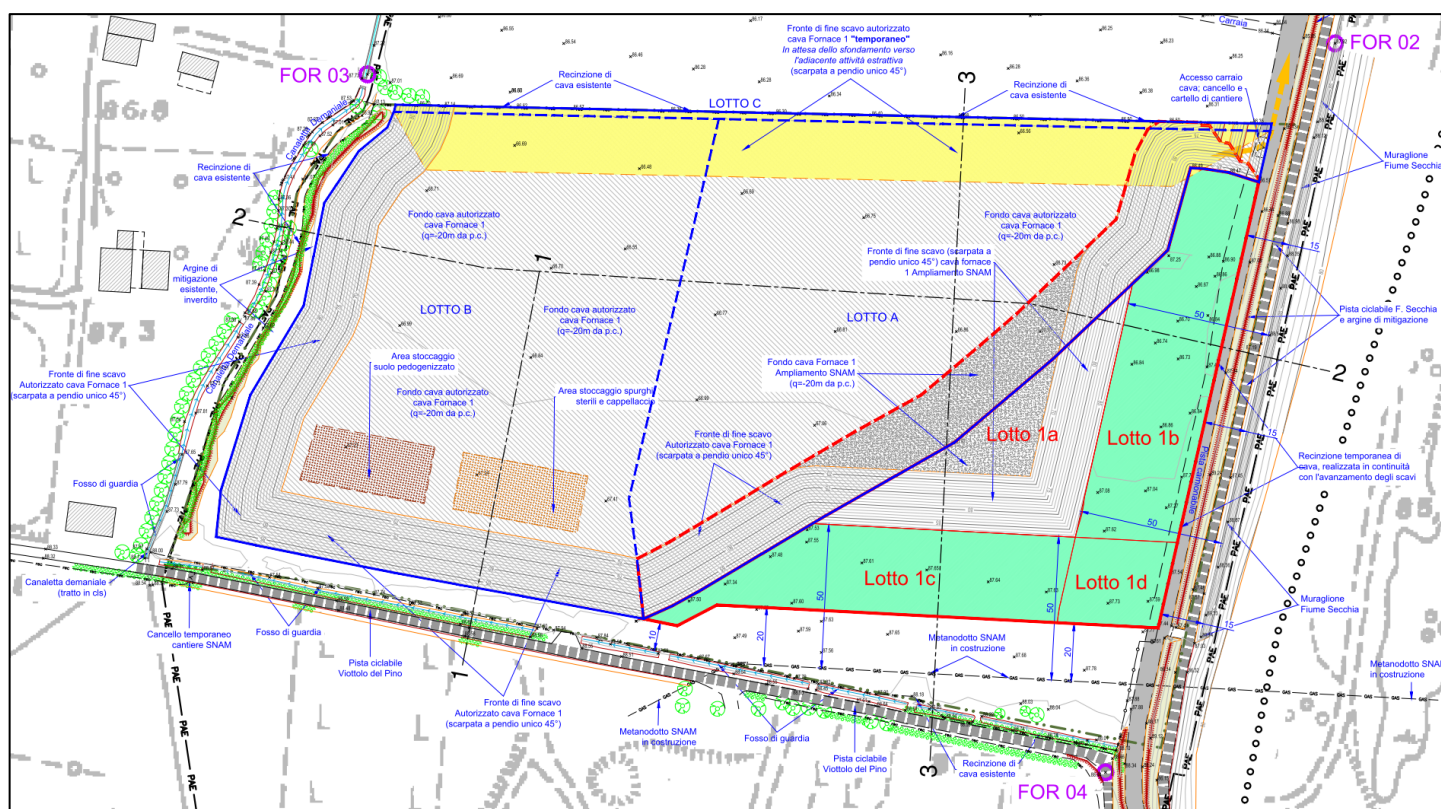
Stralcio Tav. 06 – "Progetto - Planimetria di minimo scavo".
